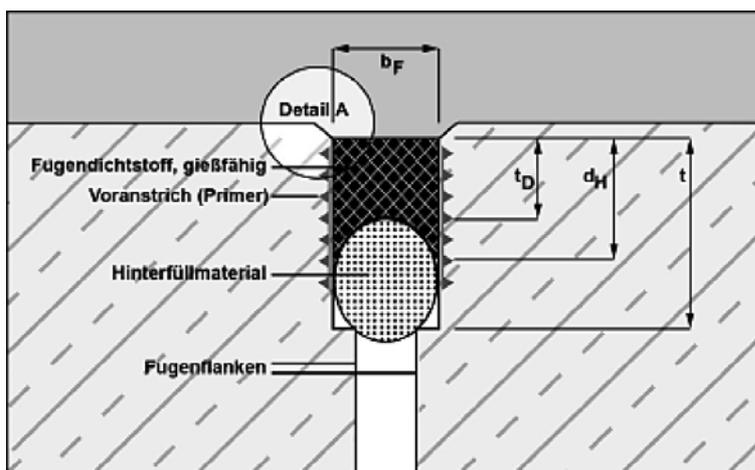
Befahrbare Fugenkonstruktion, Kontaktfläche Stahlbeton
